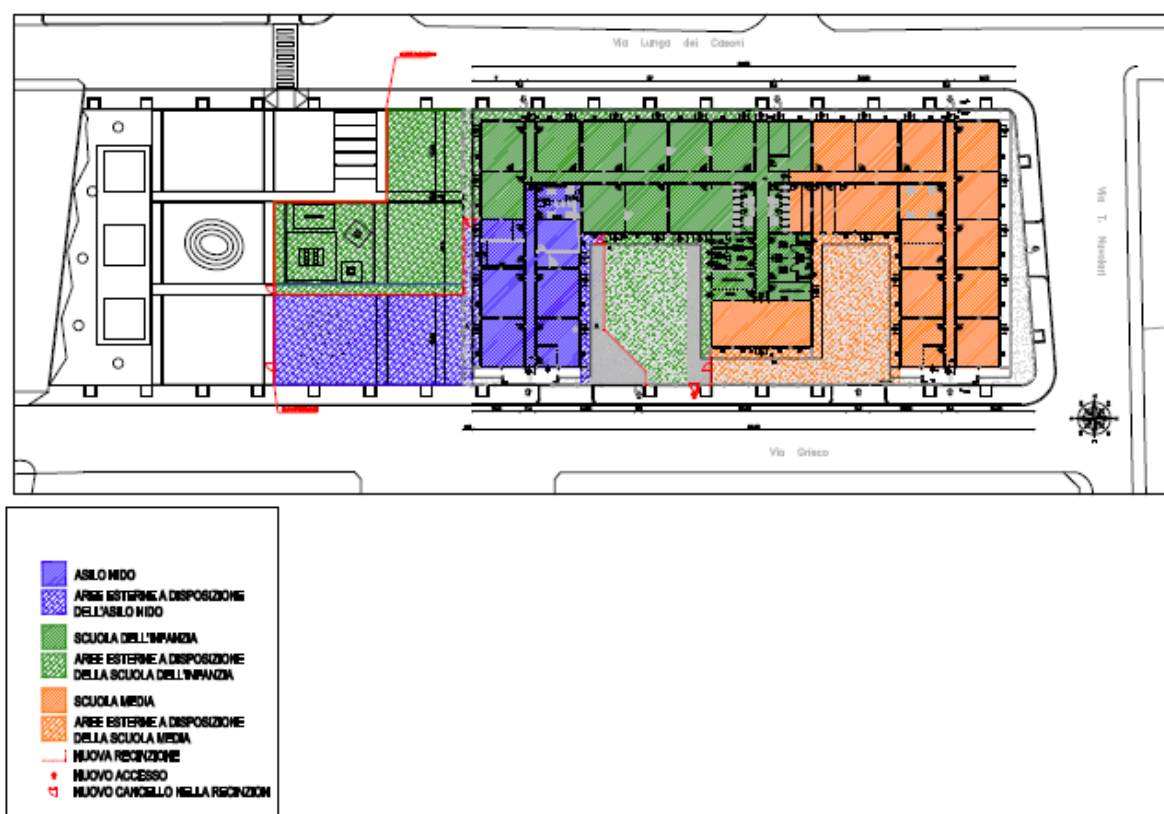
Planimetria generale della sistemazione dell'edificio scolastico esistente
